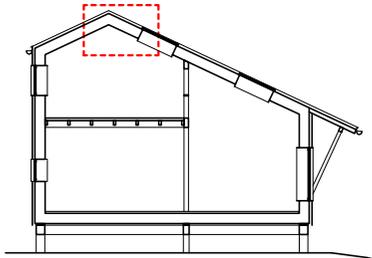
Anschluss Außenwand - Decke Galeriegeschoß M 1 : 15
